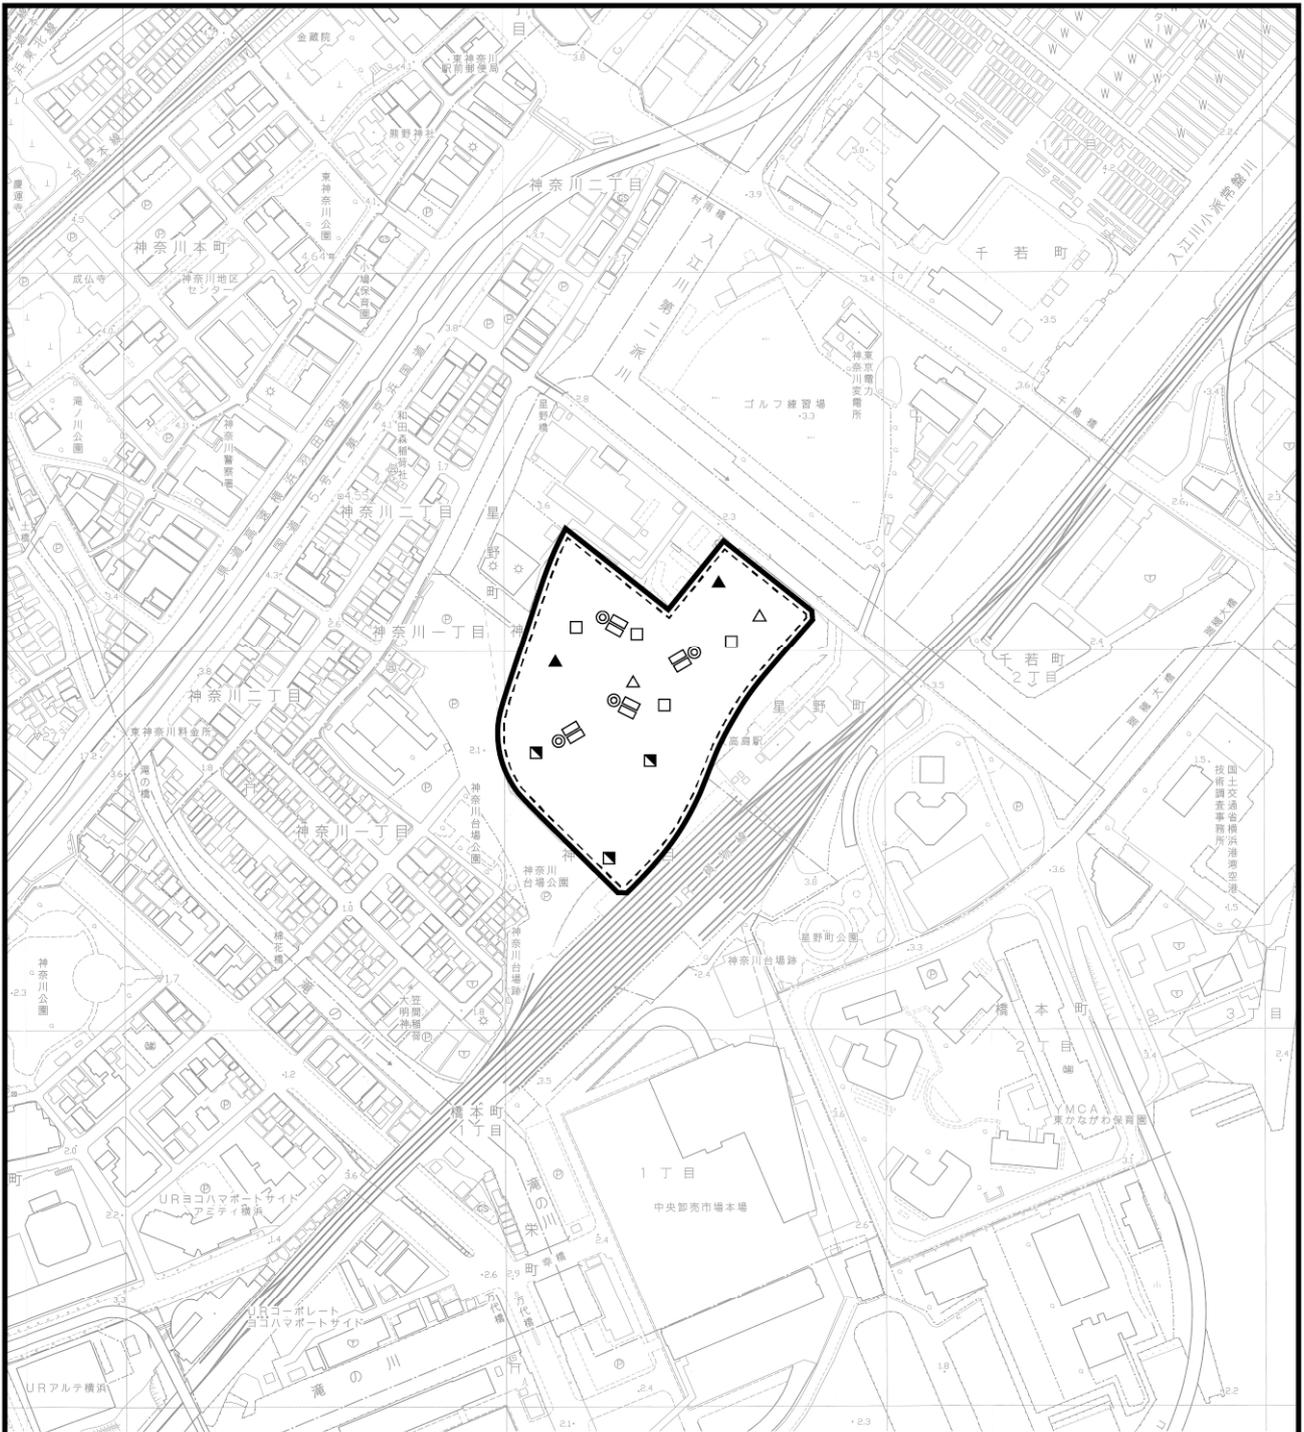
建設機械配置図 (工事開始後 20 ヶ月目)
